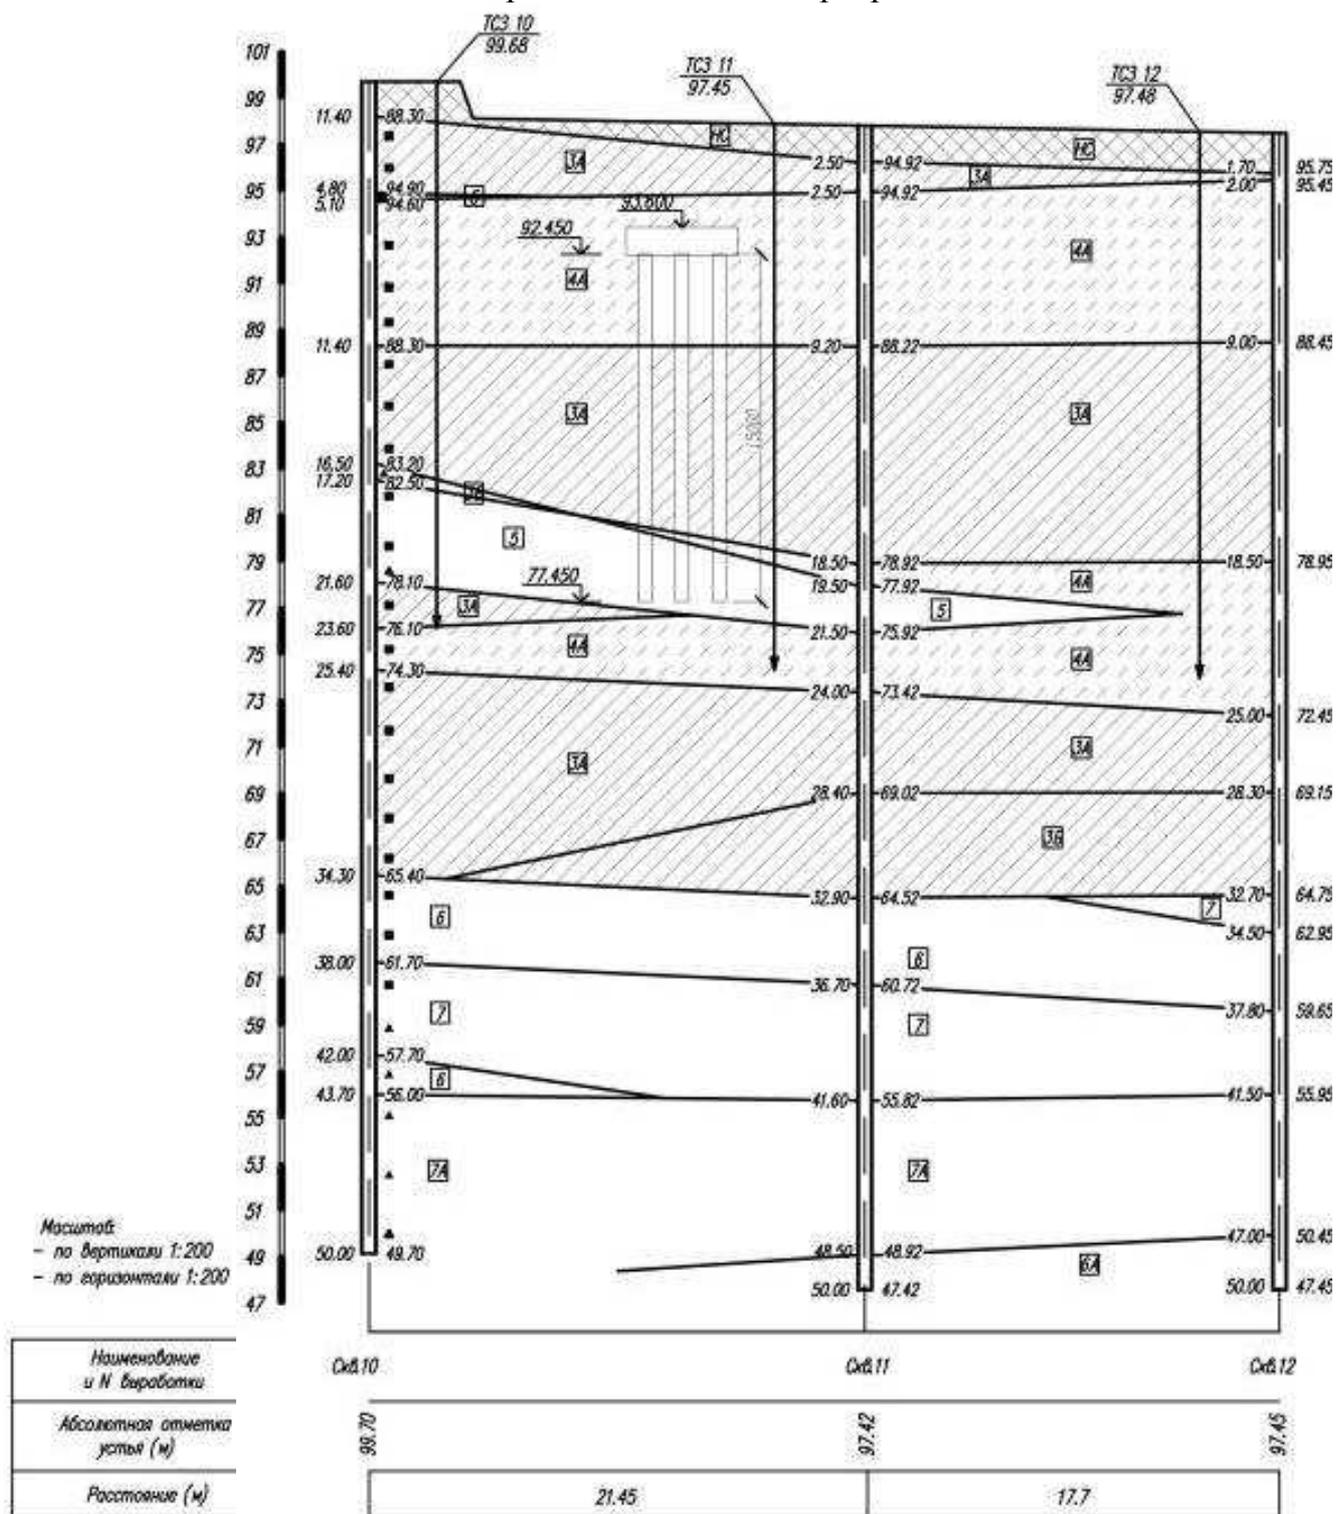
Инженерно-геологический разрез 2-2, совмещенный с масштабированной схемой проектного расположения конструкций свайно-плитного фундамента (КСПФ) высотного здания в г. Казани
